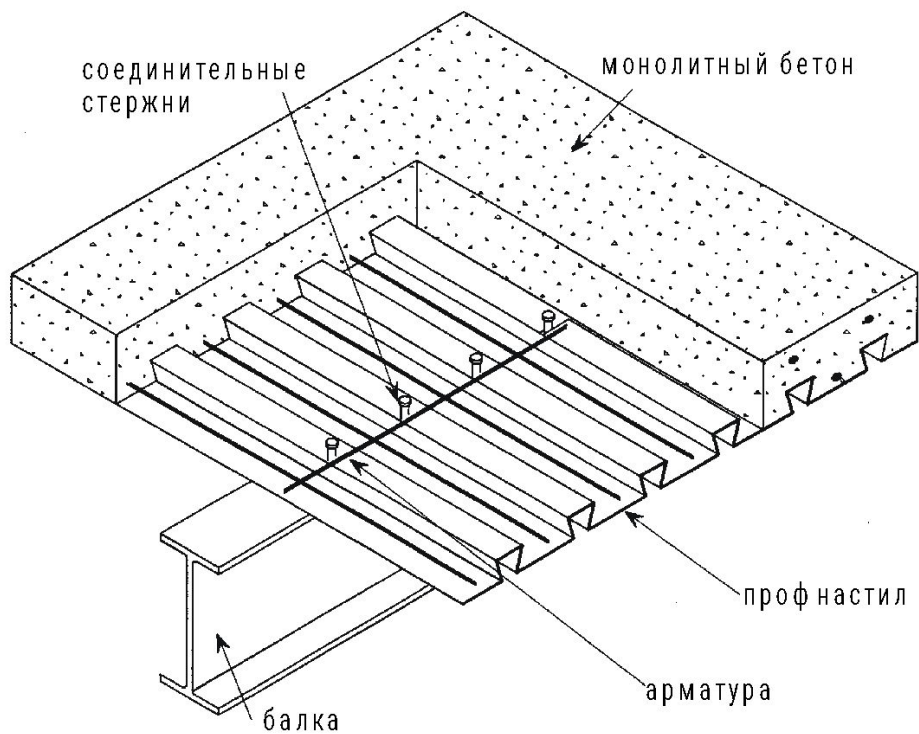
Сталебетонное и сборное плоское перекрытие
